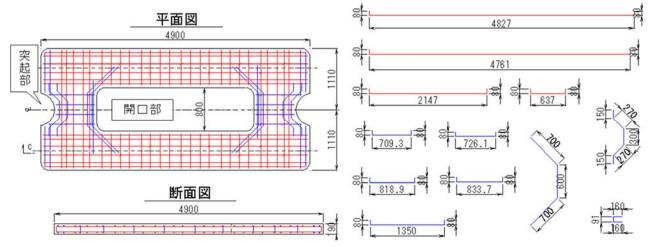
軌道スラブの配筋図と加工図(赤色:自動化対象鉄筋)
